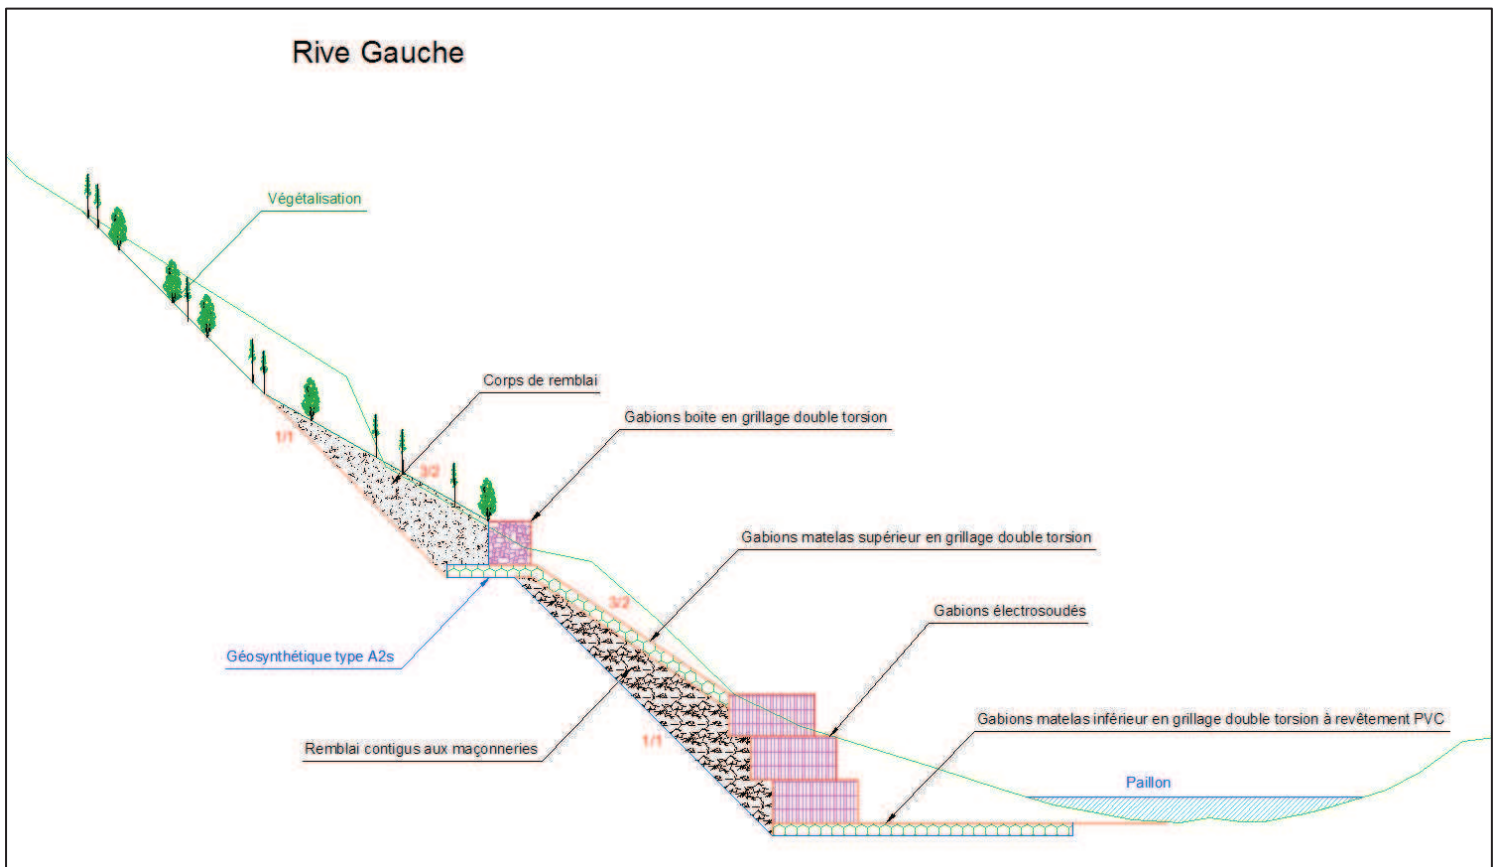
Profil en travers type du parement en gabions (Source : Systra, 2013)
